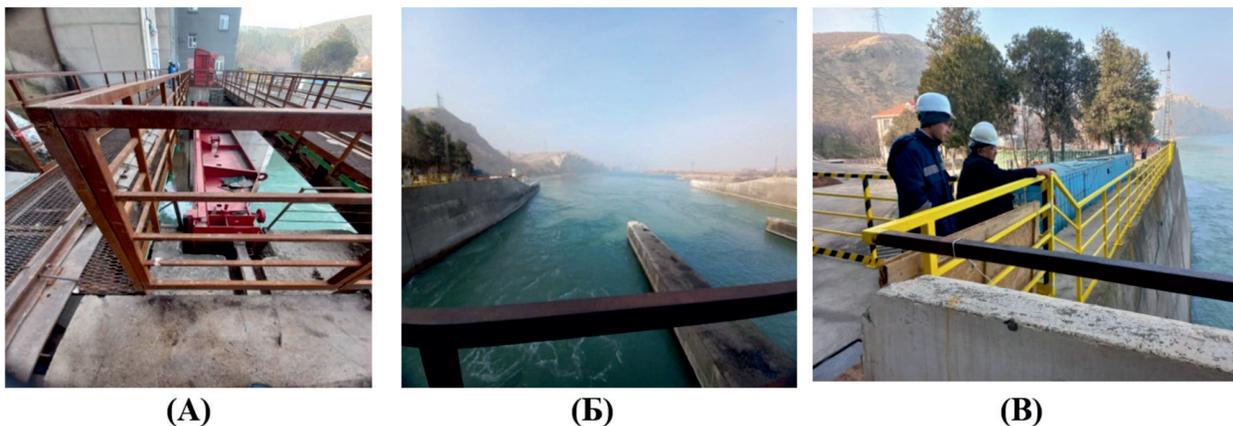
Водосбросной пролет в работе (верхний бьеф); Б - Действующий водосбросной пролет бетонной плотины (нижний бьеф); В – нижний бьеф водосбросного пролета.
